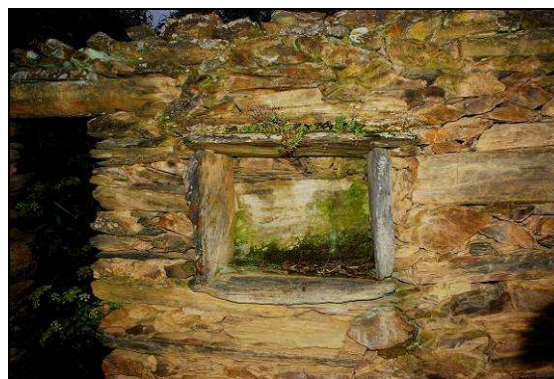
Nicho do anexo interior do muro da Ribeira do Muro.
